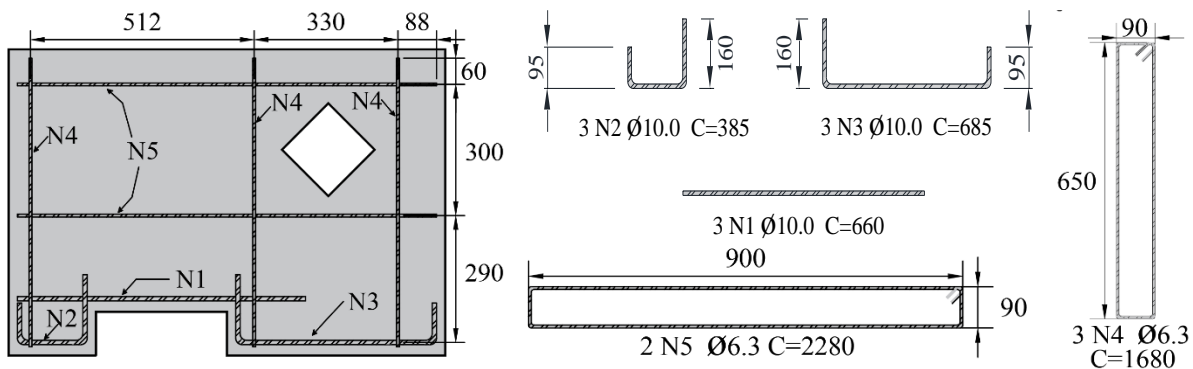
Detalhamento das armaduras de DB1-W-H1-U, DB3-W-H1-U, DB3-W-H1-S-F (dimensões mm)
